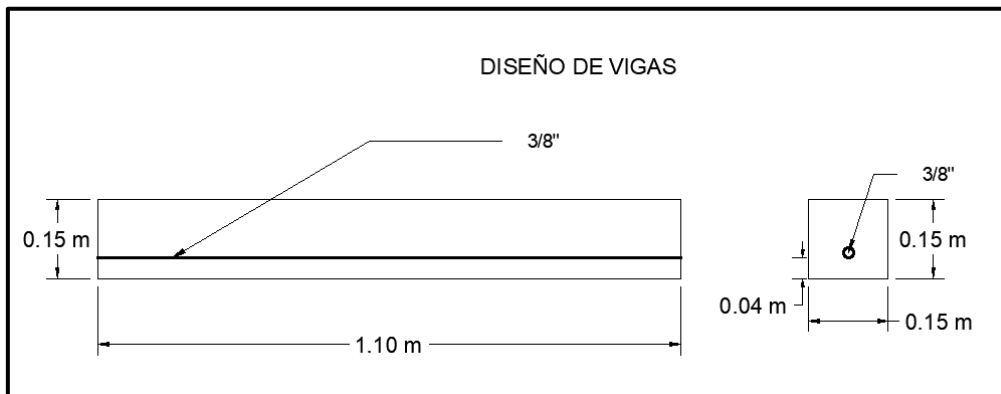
Elaboración de vigas de concreto*Figura 82*Diseño de las vigas de concreto
